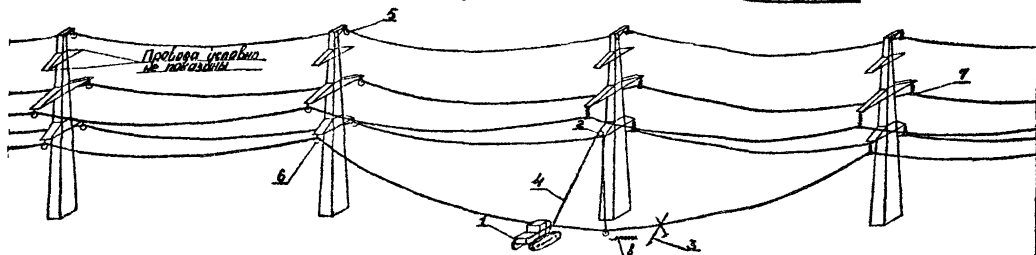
Узел Я. Перекладка провода верхней траверсы с опусканием
